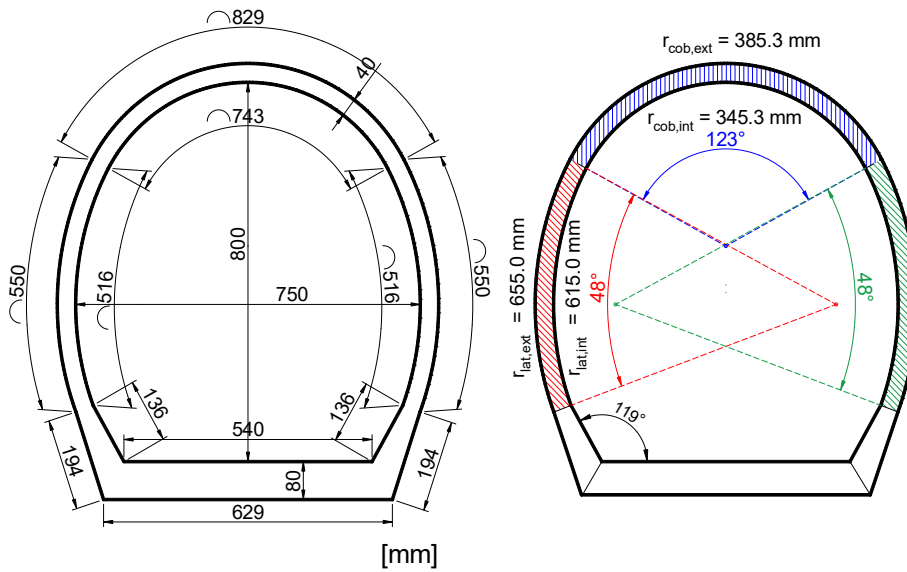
Forma 1: Dimensões estabelecidas para o protótipo moldado com UHPC (esp. arco 20 mm)
